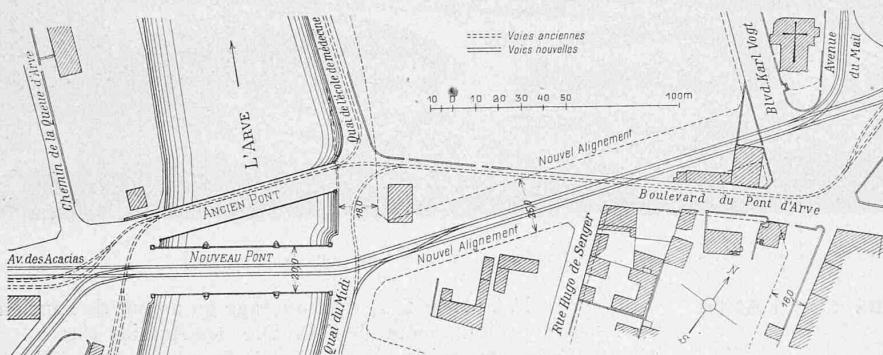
Plan de situation de l'ancien et du nouveau pont. — Echelle 1 : 3000.
